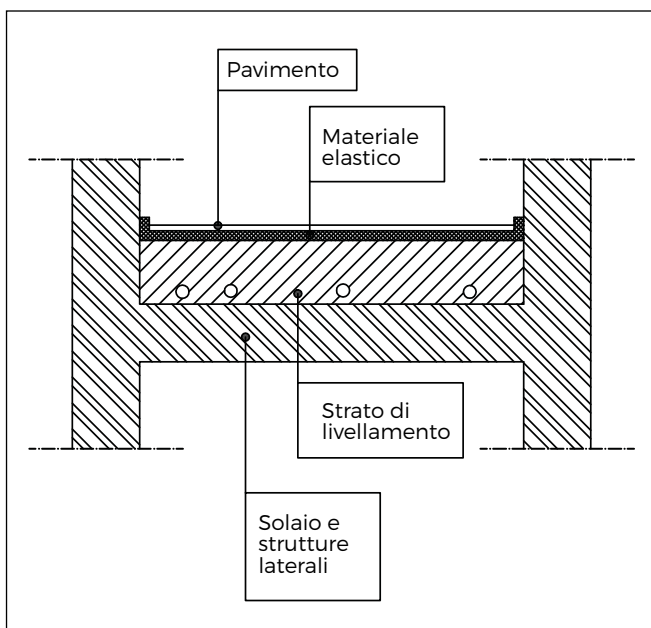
Schema isolamento con materiale resiliente sottopavimento
